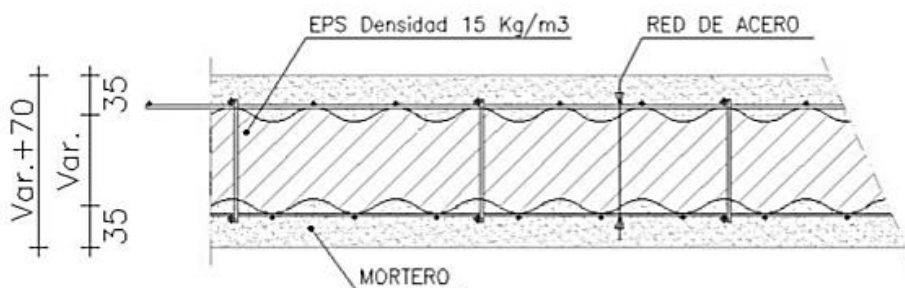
Detalle losa sistema constructivo EMMEDUE (M2). Fuente (Lora, 2015)
